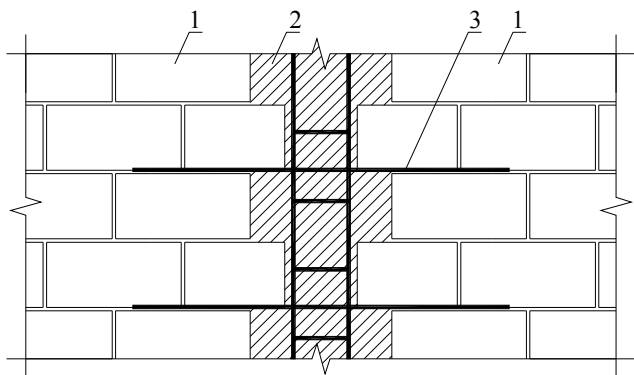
预制砌块砌体构件竖向连接段构造示意
